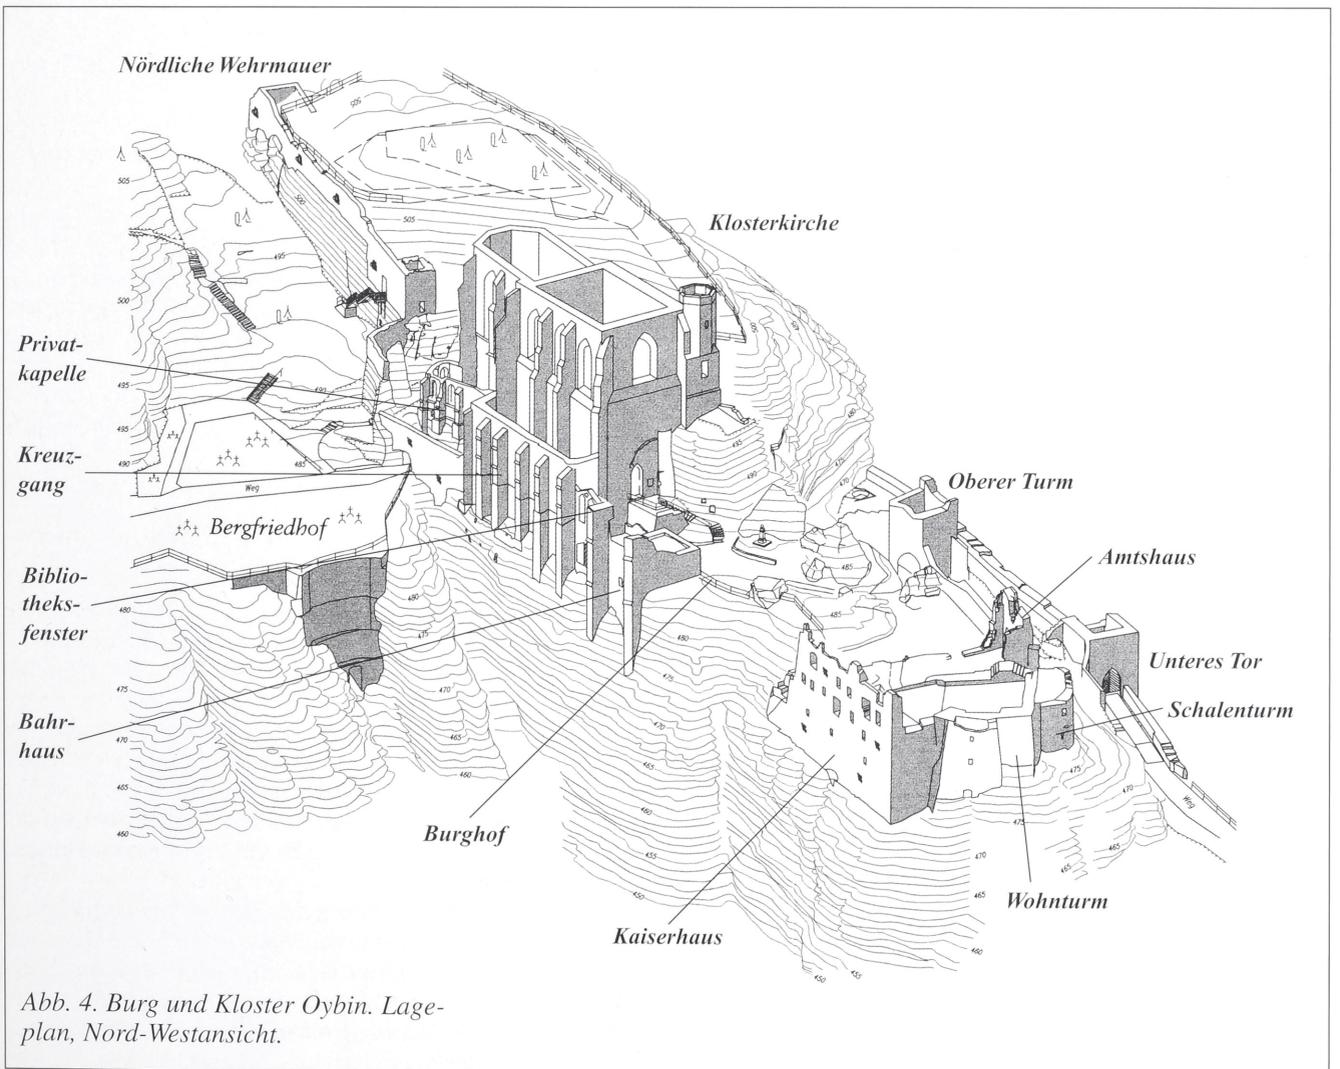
Burg und Kloster Oybin. Lageplan, Nord-Westansicht.
